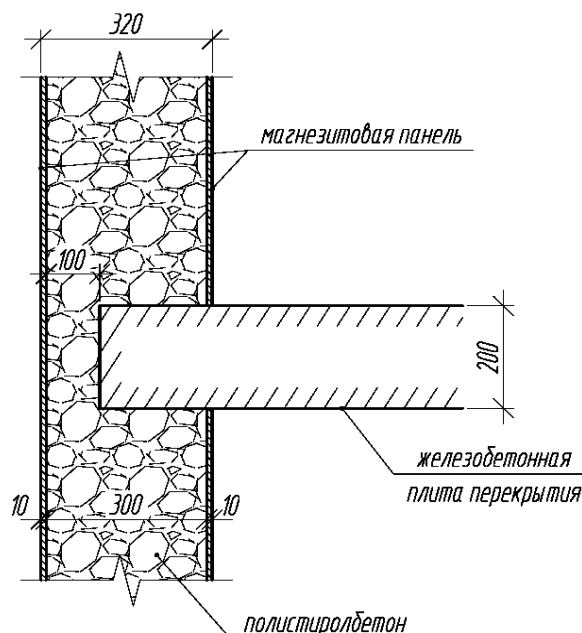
Узел сопряжения наружной комплексной стены с монолитным железобетонным перекрытием.
